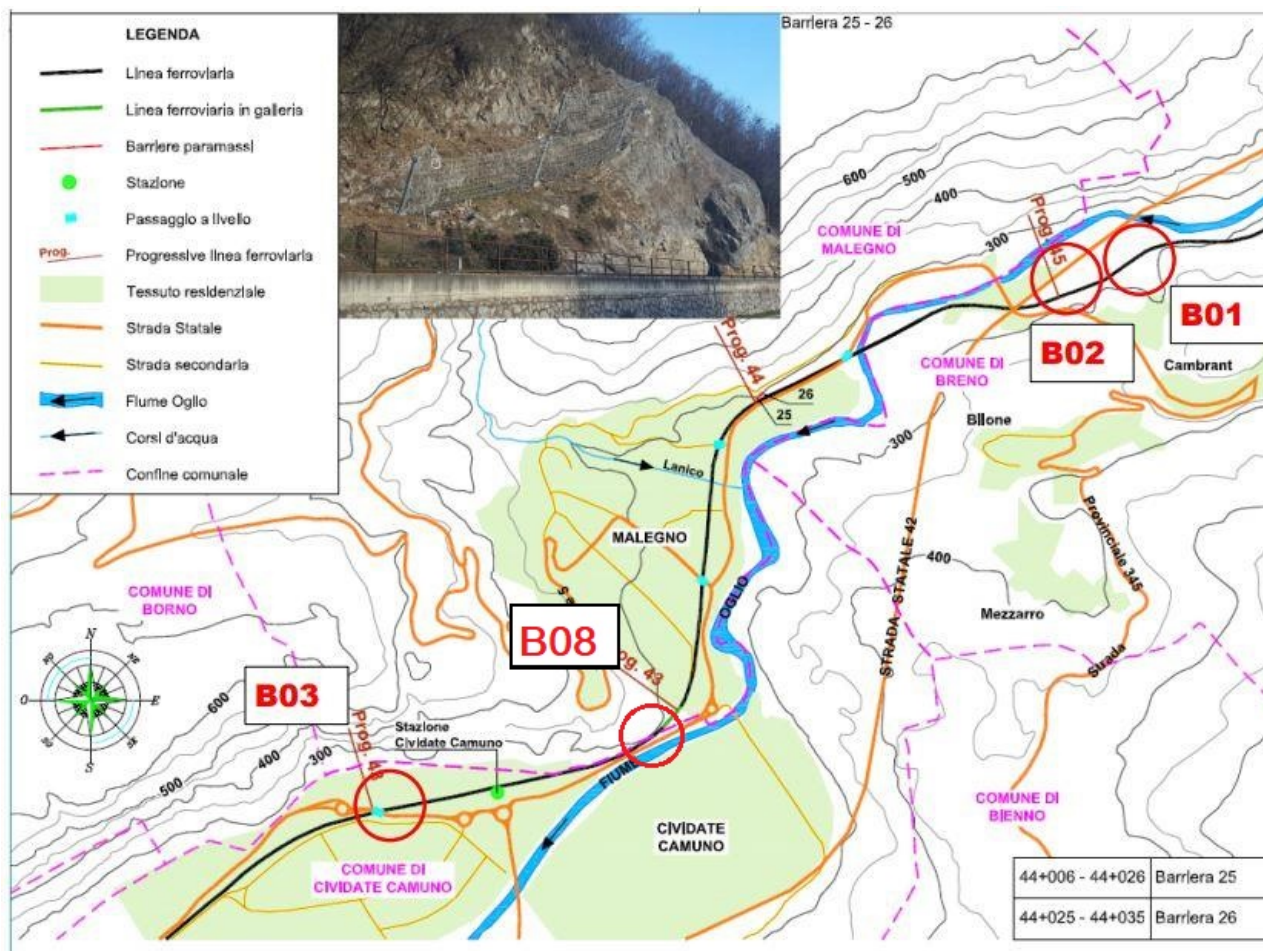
Localizzazione degli interventi su planimetria di progetto
